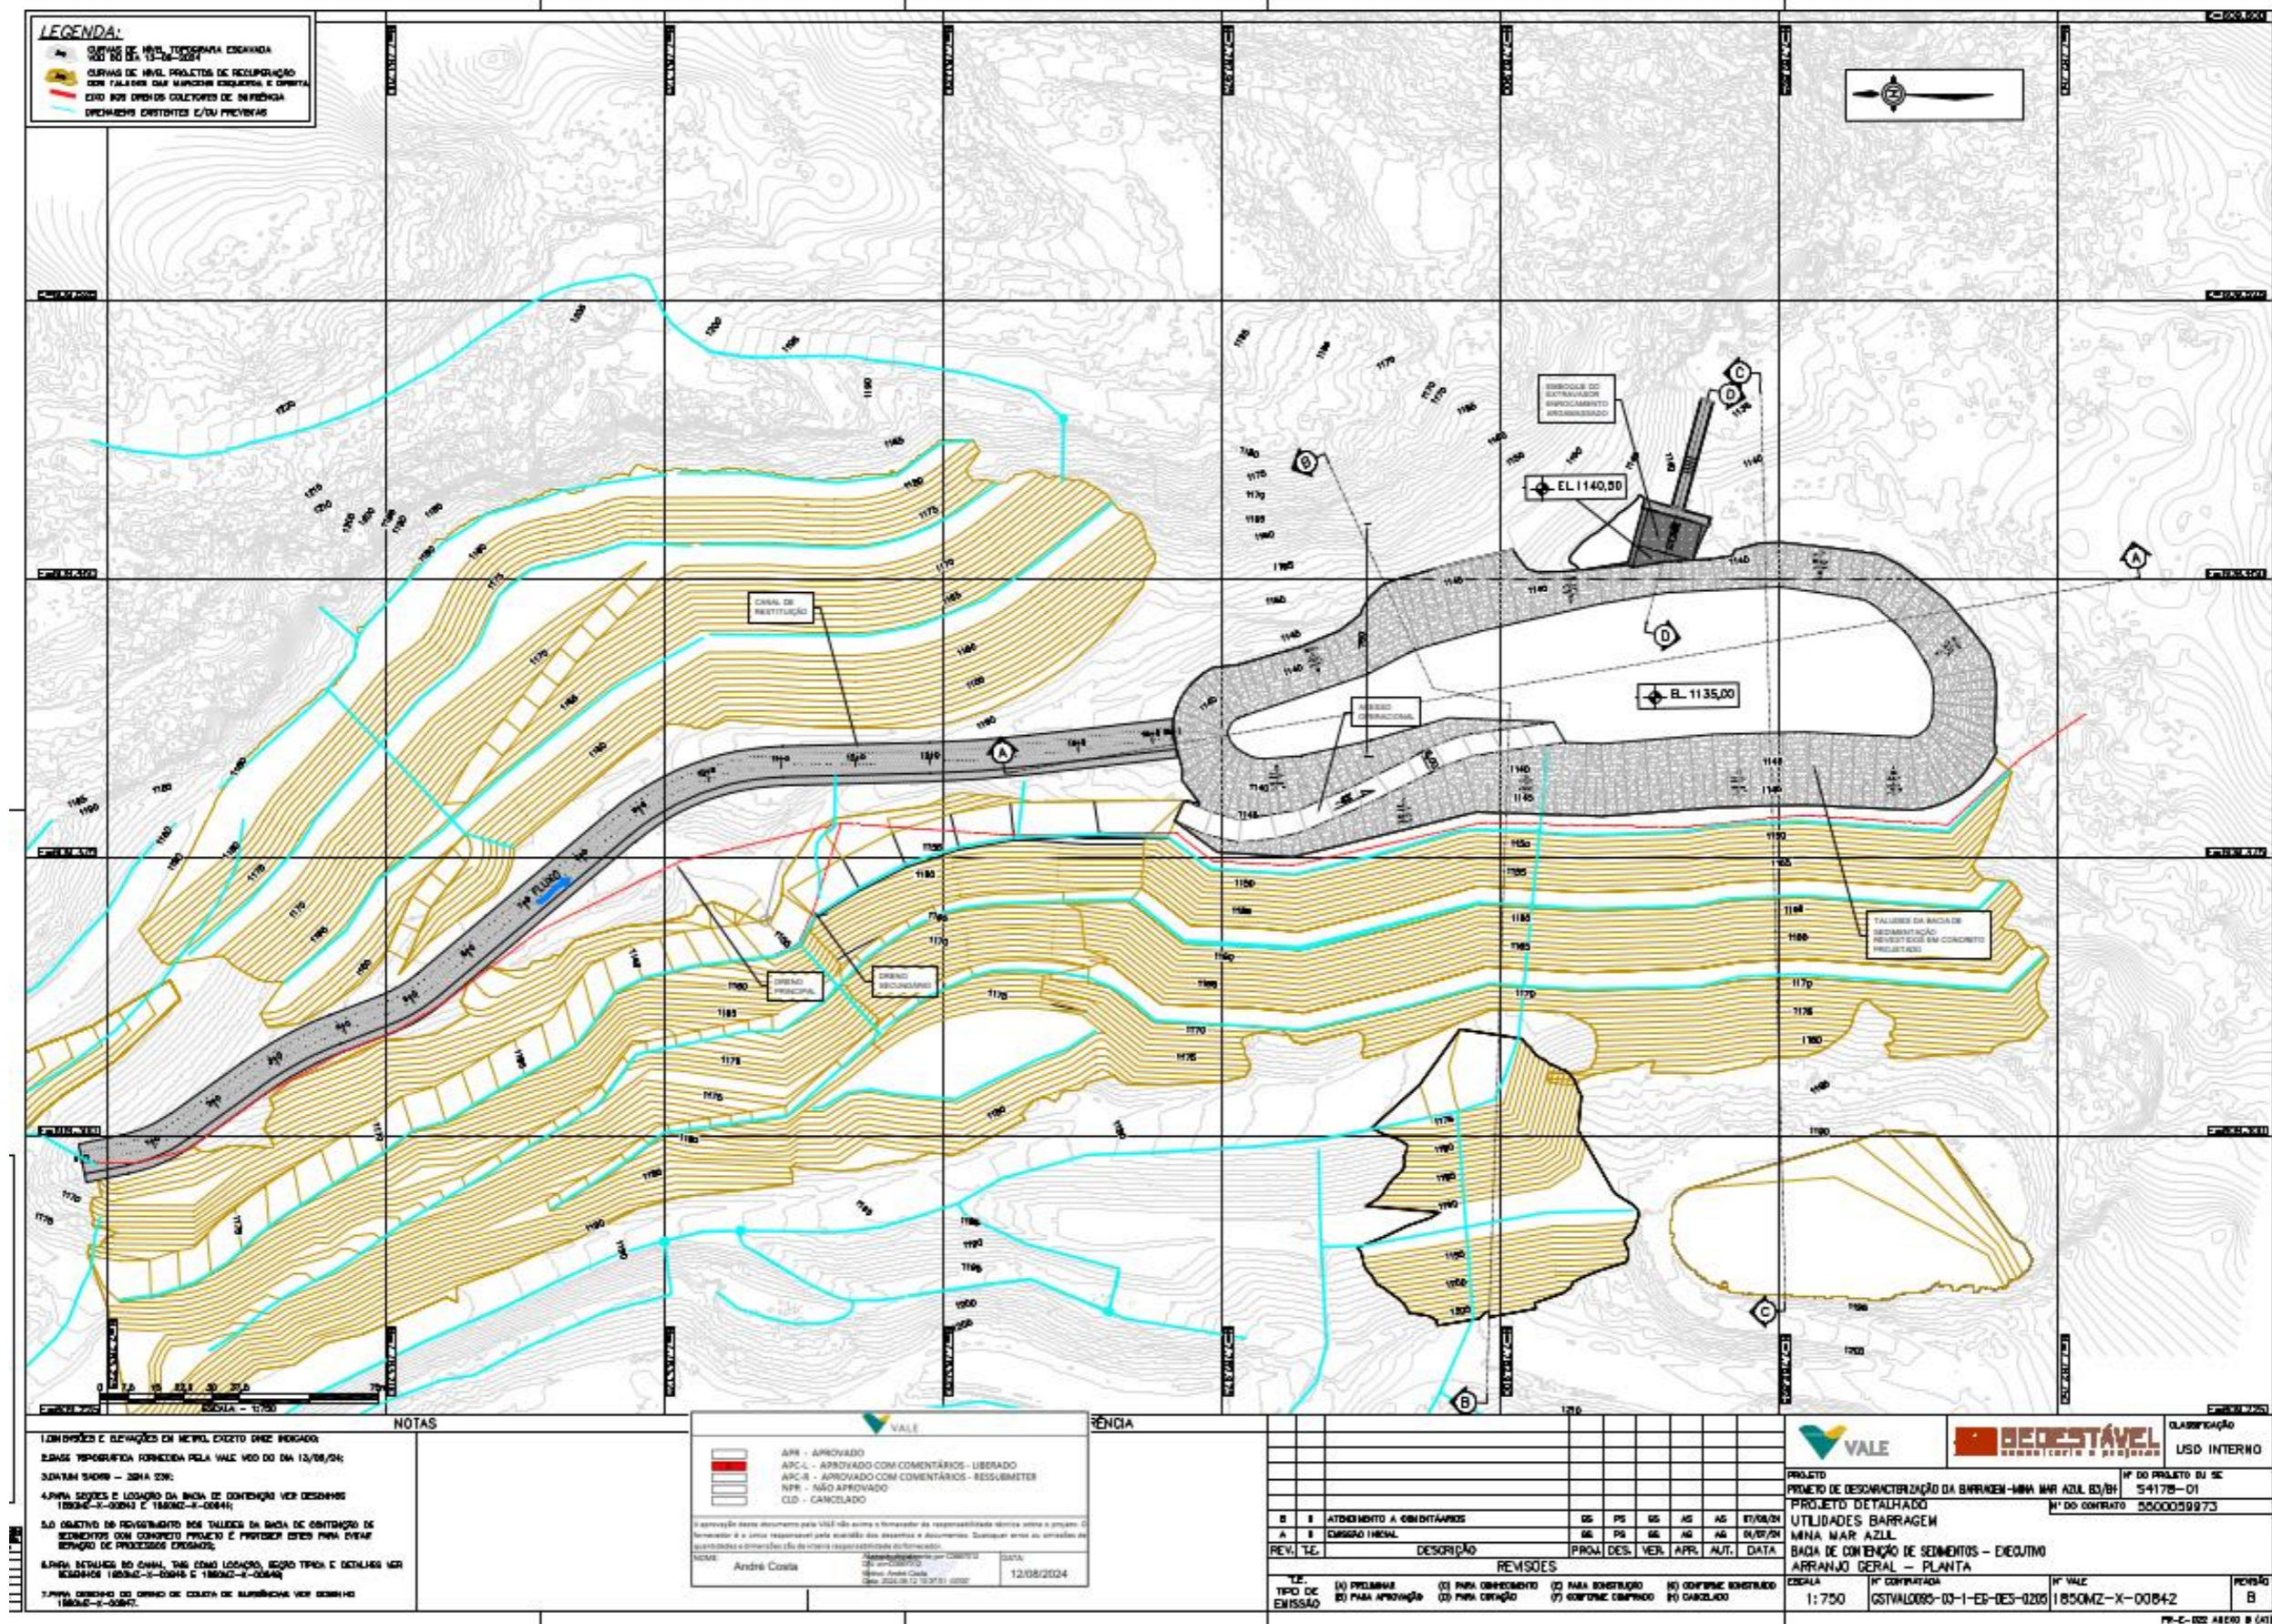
Barragem B3B4 - Conformação Final – Arranjo Bacia de Contenção de Sedimentos e Canal Central – Executivo.
